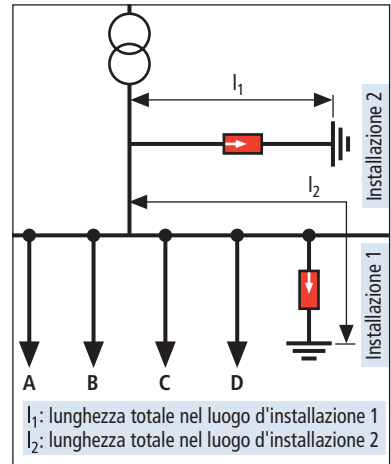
Disposizione dei dispositivi di protezione nell'impianto e la lunghezza di collegamento efficace risultante
